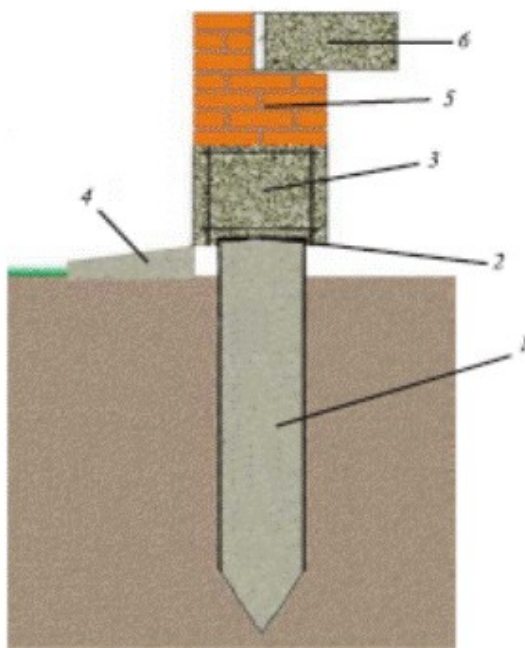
Свайный фундамент: 1 – бетонная свая; 2 – гидроизоляция; 3 – железобетонный пояс; 4 – отмостка; 5 – стенка цоколя из кирпича; 6 – железобетонная плита перекрытия
